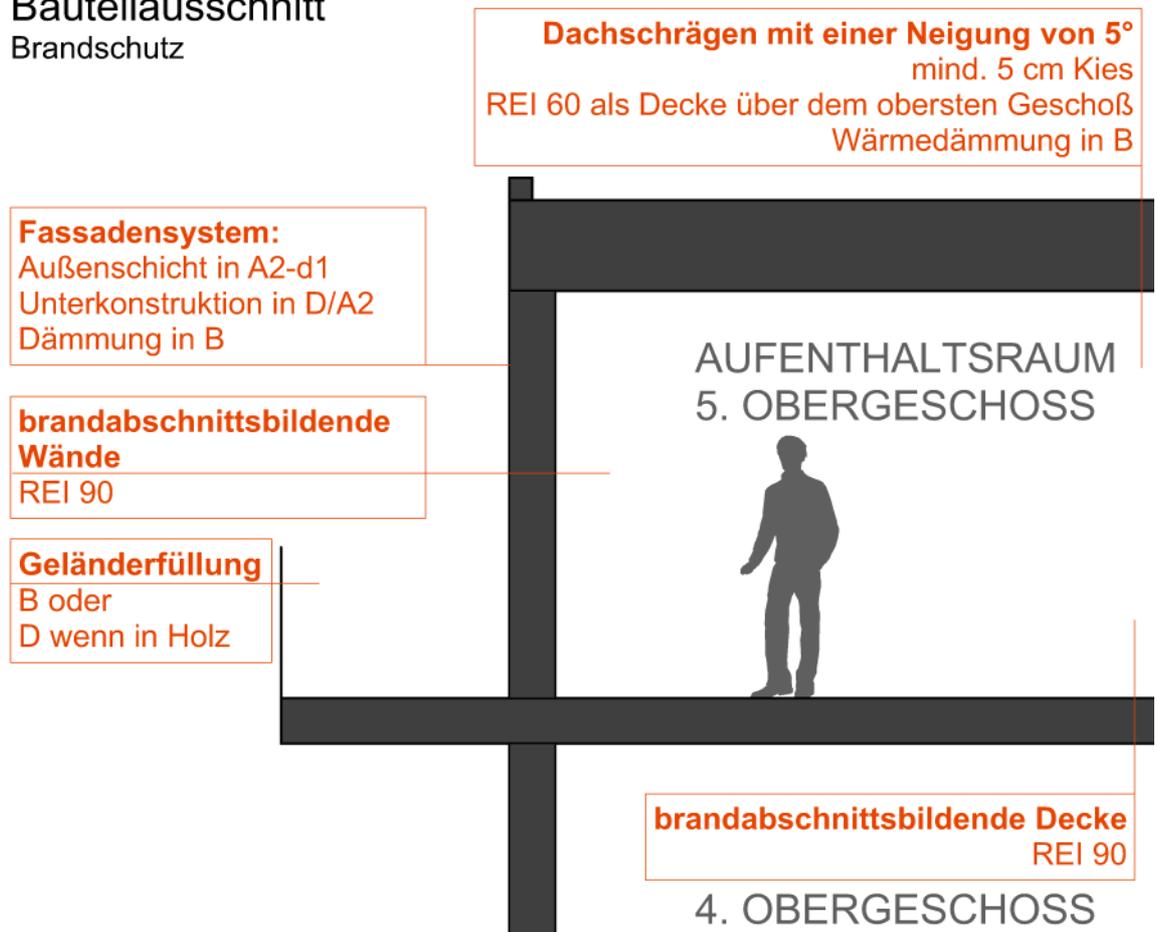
Bauteilausschnitt: Brandschutz 1:50
